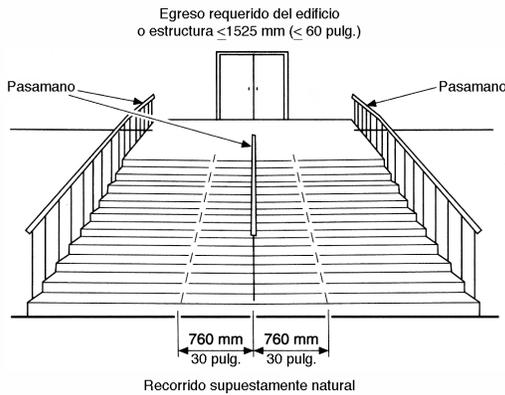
Detalles de la Baranda.
